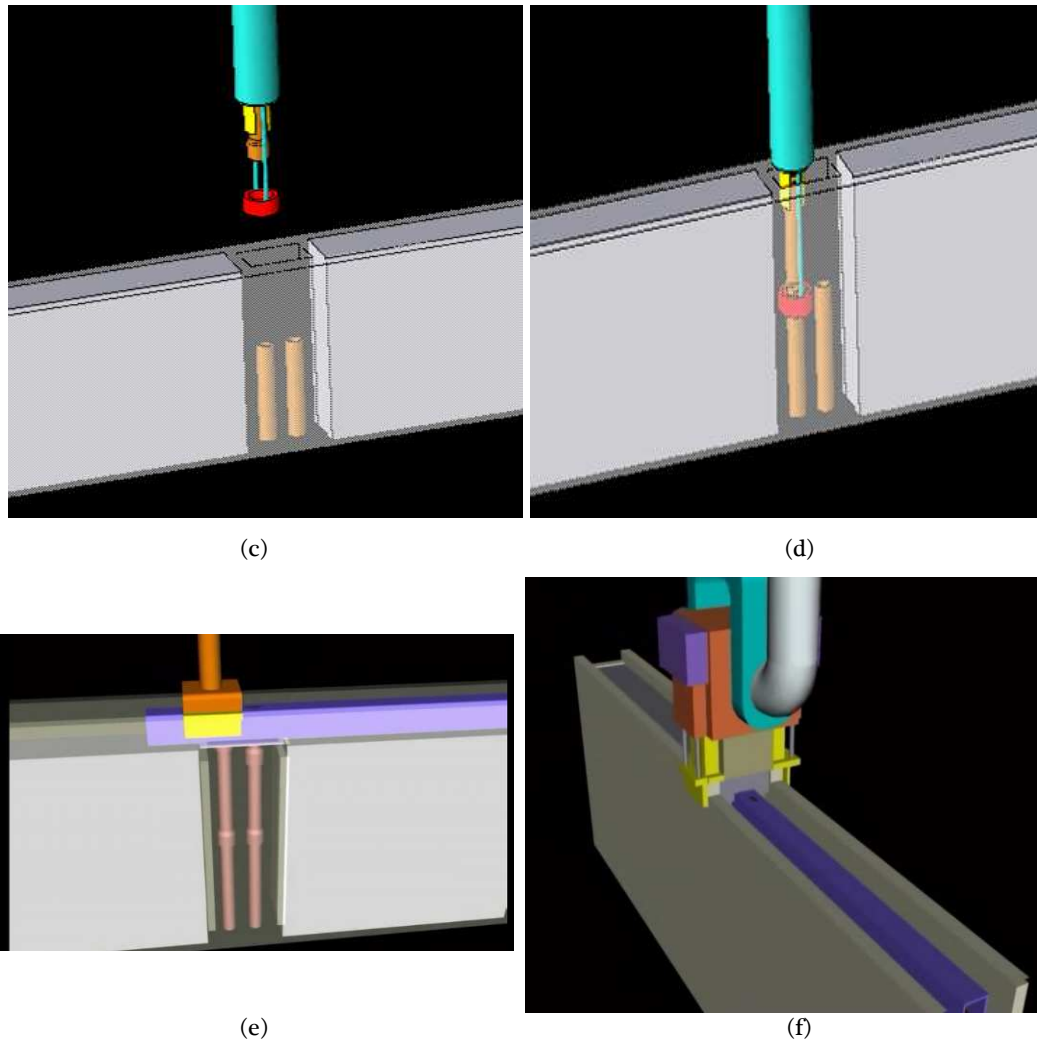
Sistema para la conexión de las instalaciones de fontanería. Fuente: Contour Crafting.
